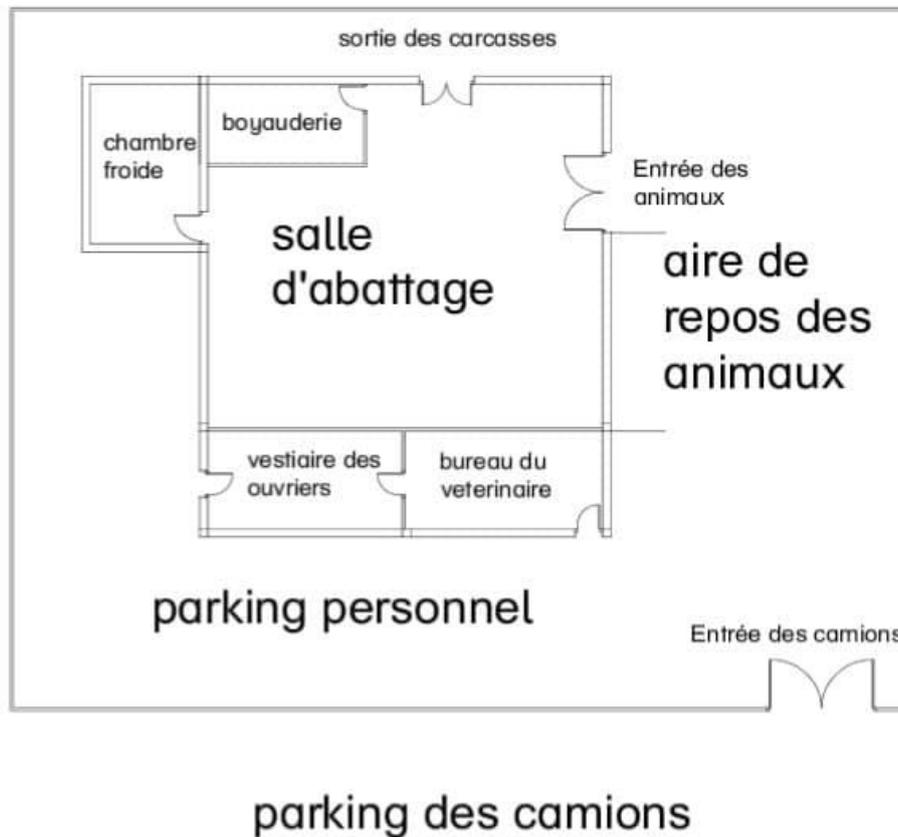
Plan de l'abattoir d'AZAZGA (plan personnel)
